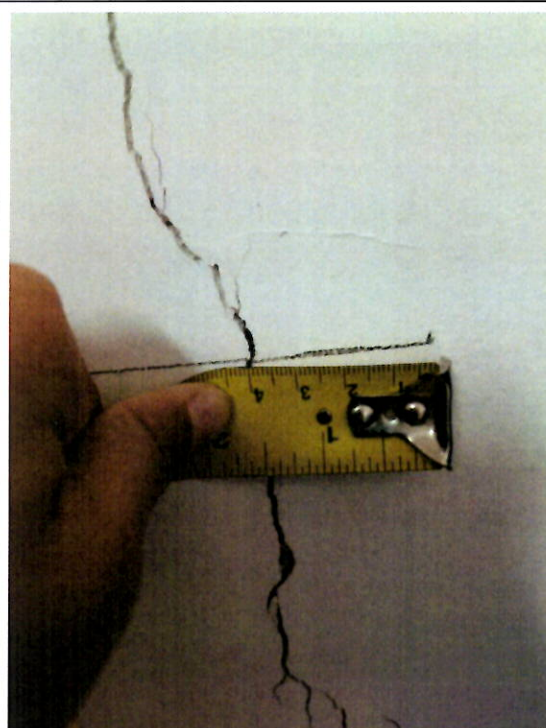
Detalhe das trincas que já foram marcadas para monitoramento anteriormente.
